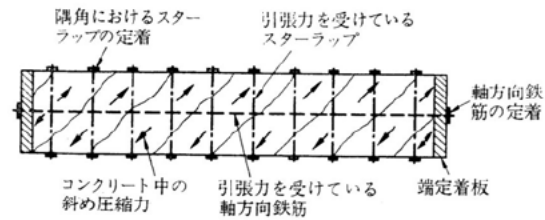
理想化したコンクリートと鉄筋の機能¹⁴⁾
